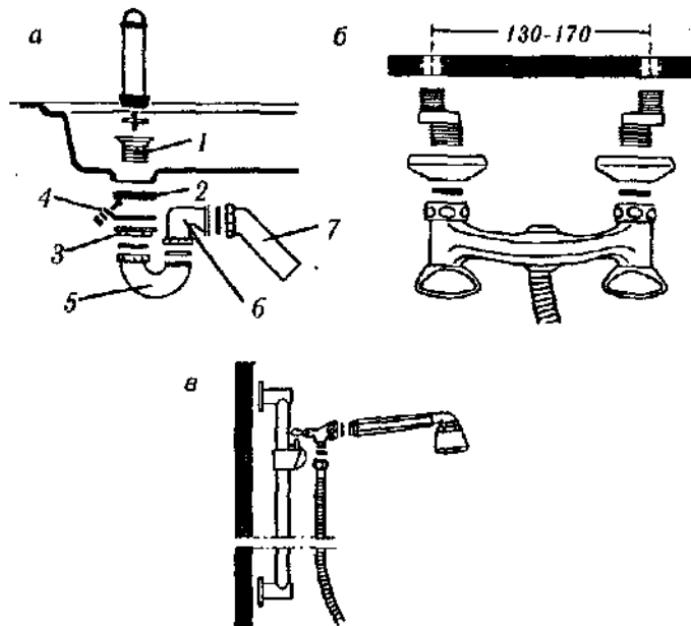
Монтаж душа: а — монтаж сливного оборудования; б — монтаж смесителя душа; в — крепление настенной штанги и шланга; 1 — выпуск; 2 — прокладка; 3 — контргайка; 4 — пластина; 5 — сифон; 6 — угольник; 7 — отвод.
